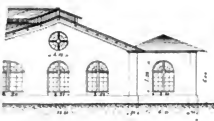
Detail de la Charpente (Dépôt d'ELVAS 16 Machines)
